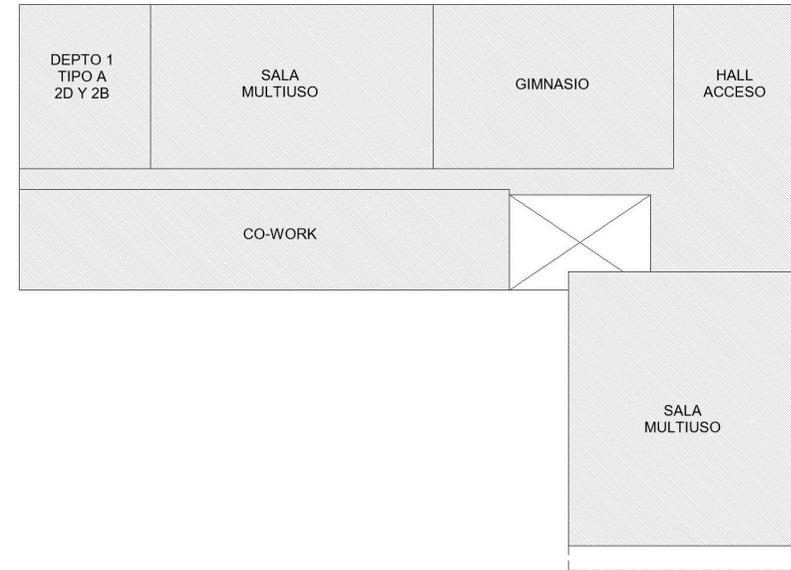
Planta Emplazamiento Cabida Uso Residencial.
